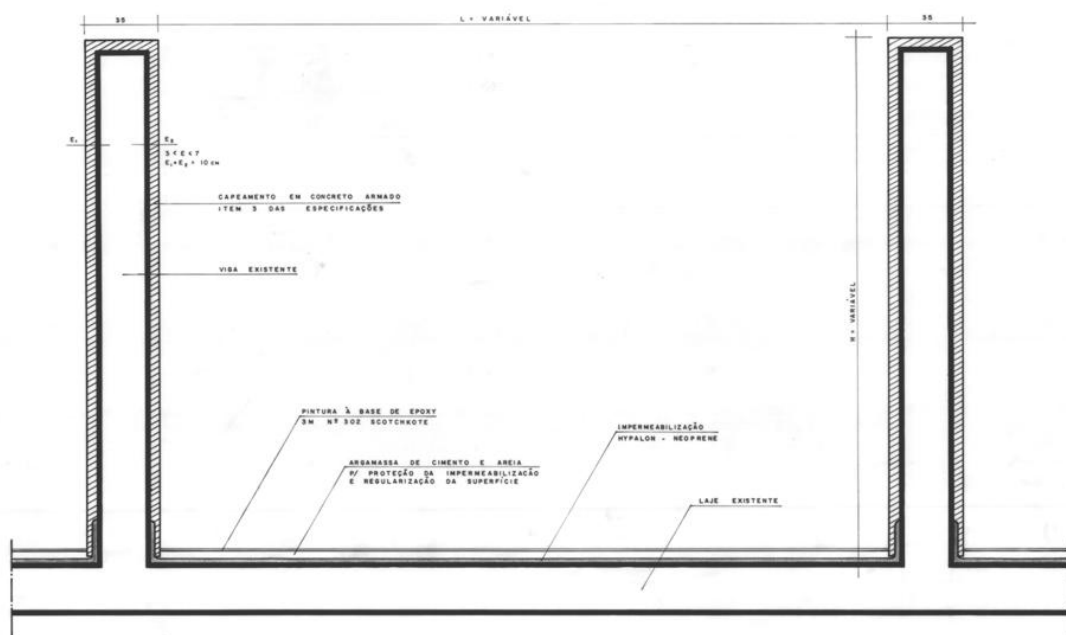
Detalhe: Corte Transversal/Detalhe (1967). Carimbo: Teatros Oficiais no Setor Cultural Norte, TOSC, DD 55/1. Conteúdo: Fachadas leste e oeste, acabamento das vigas e lajes. Desenho: Igor. Data: 25/10/1967. Fonte: ARPDF.
